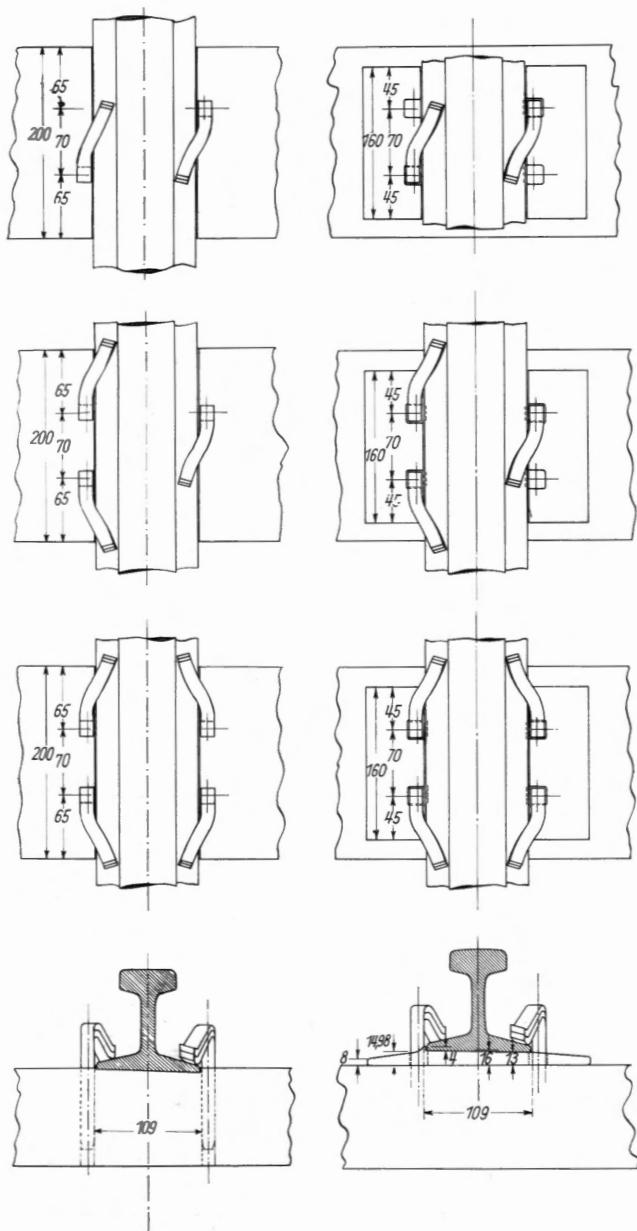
Befestigung der 30,1-kg/m-Schienen mit zwei, drei oder vier Federnägeln auf Holzschwellen ohne und mit Unterlagsplatten.
